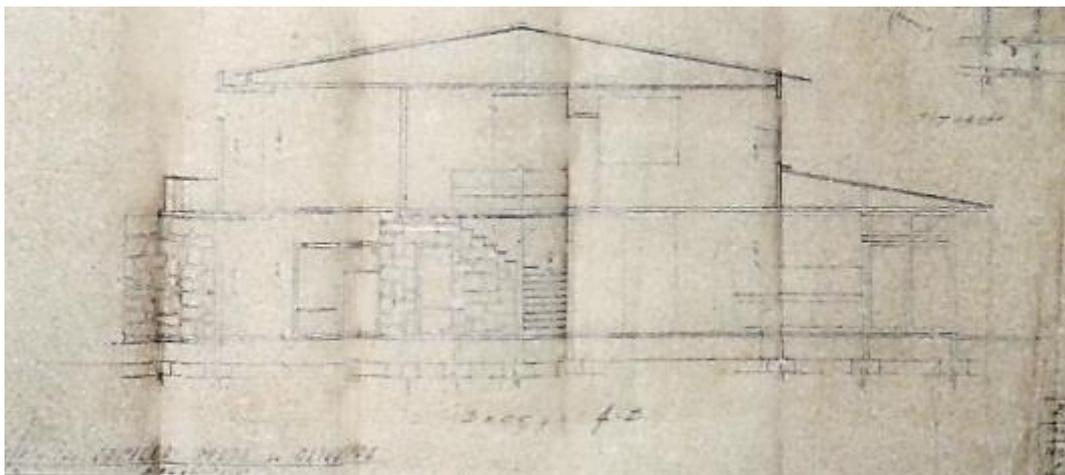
Seção Longitudinal da Casa Davina Monteiro. Fonte: Acervo LAHCA.
